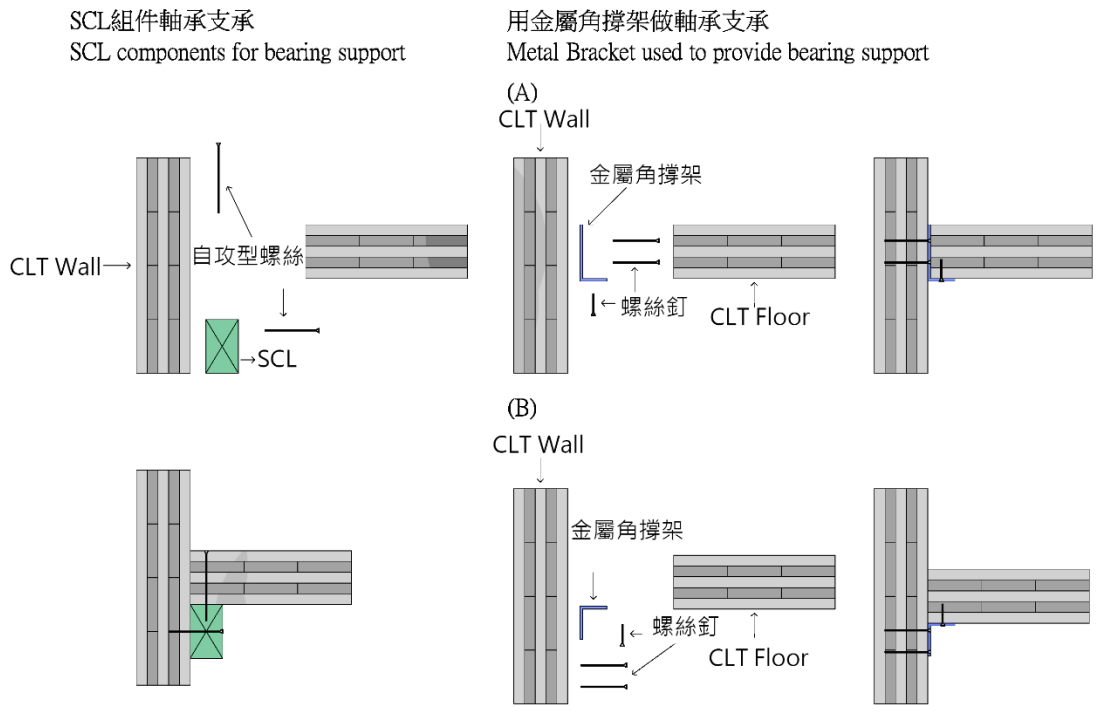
(f) Wall to Floor(Ballon System)主要接合形式
